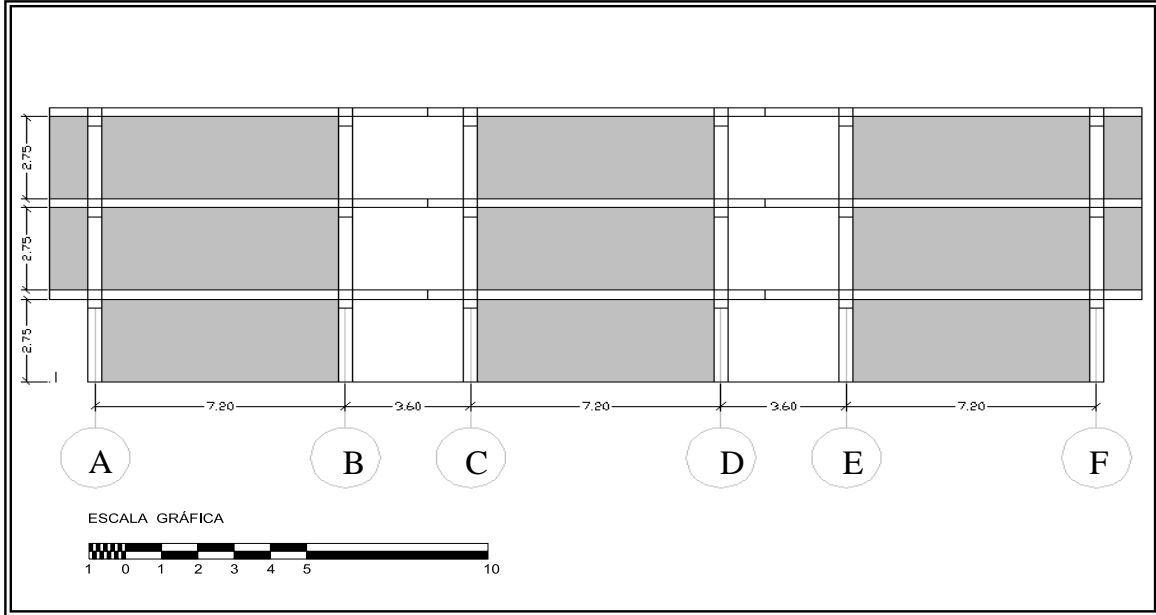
Pórtico 6 (norte-sur) mostrando las paredes de mampostería y la longitud efectiva de columnas
